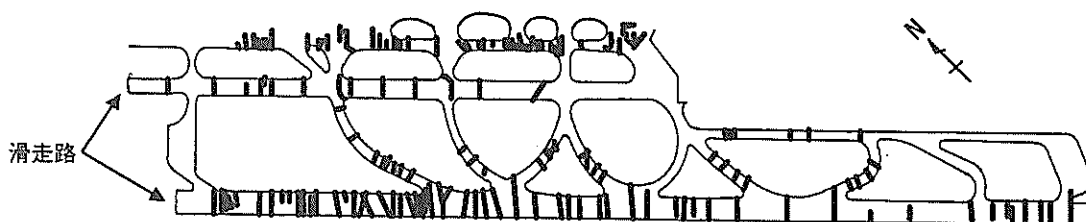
地震により空港舗装により生じたひび割れの位置
